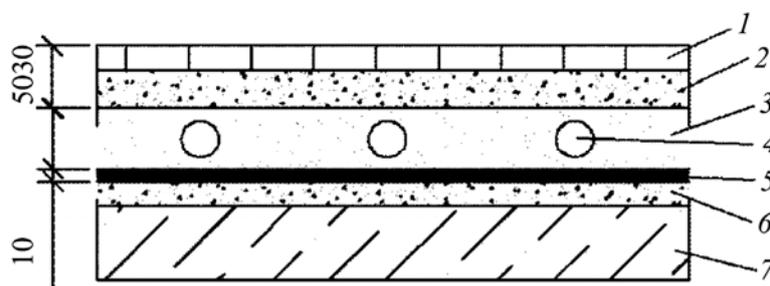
Схема конструкции обходной дорожки крытых бассейнов: 1 — керамическая плитка; 2 — цементная стяжка; 3, 4 — обогревающие трубы в слое песка; 5 — гидроизоляция на цементной стяжке; 6 — цементная стяжка; 7 — плита перекрытия
